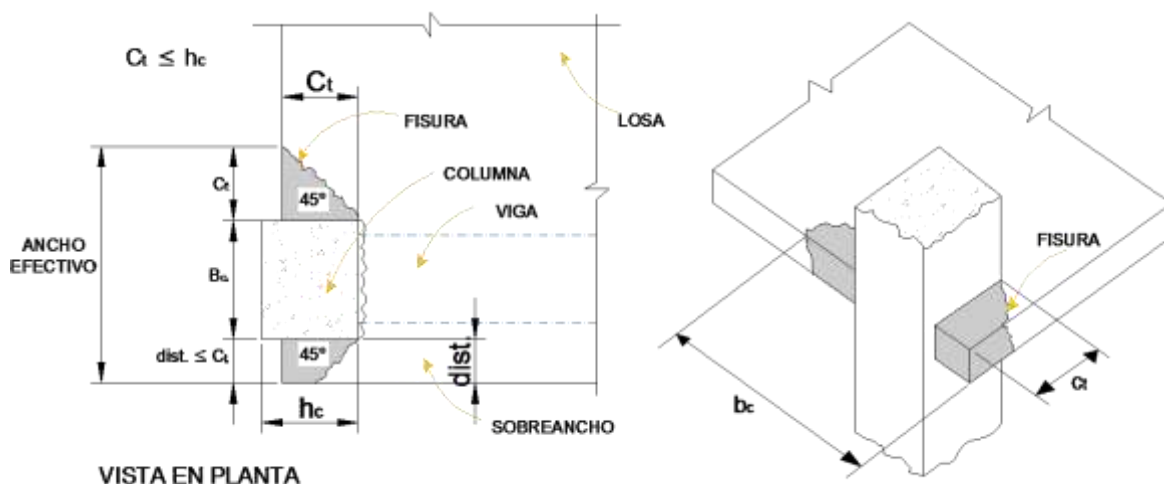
Ancho efectivo de viga en conexiones de esquina sin viga transversal
